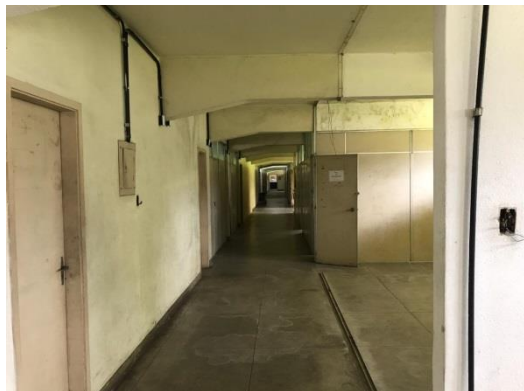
Vista geral do corredor do prédio 6, pavimento térreo
